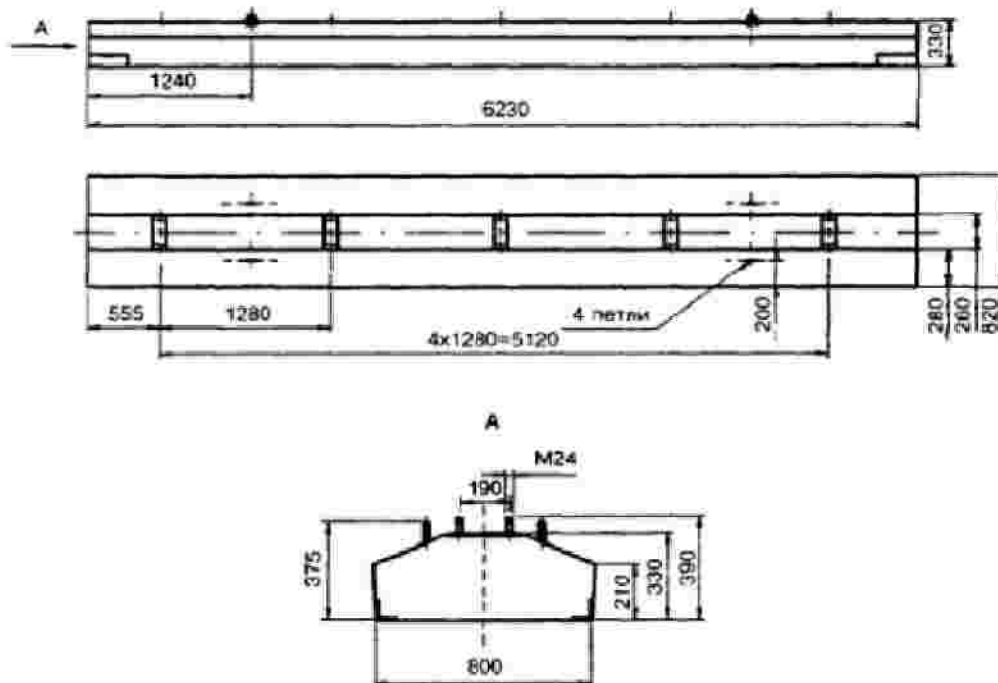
Железобетонная балка типа BRP-62.8.3
